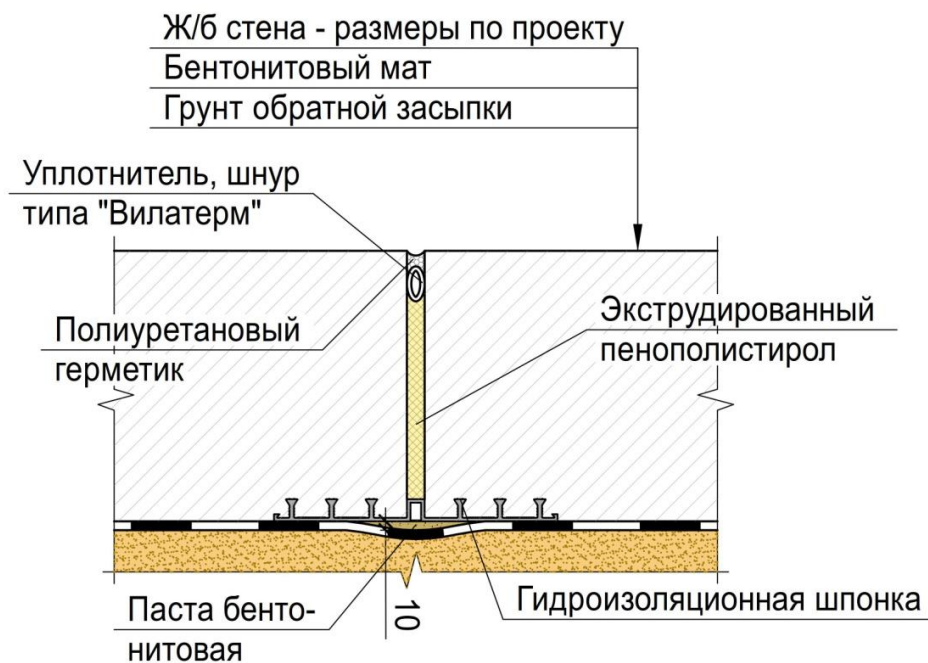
Узел устройства изоляции вертикального деформационного шва железобетонной стены.
